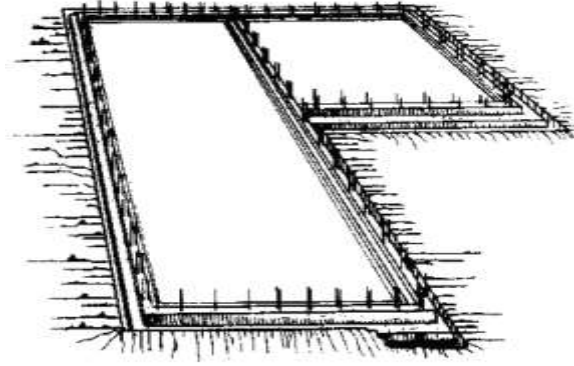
Losa de cimentación terminada con las varillas en “U” dispuestas a recibir los muros.
